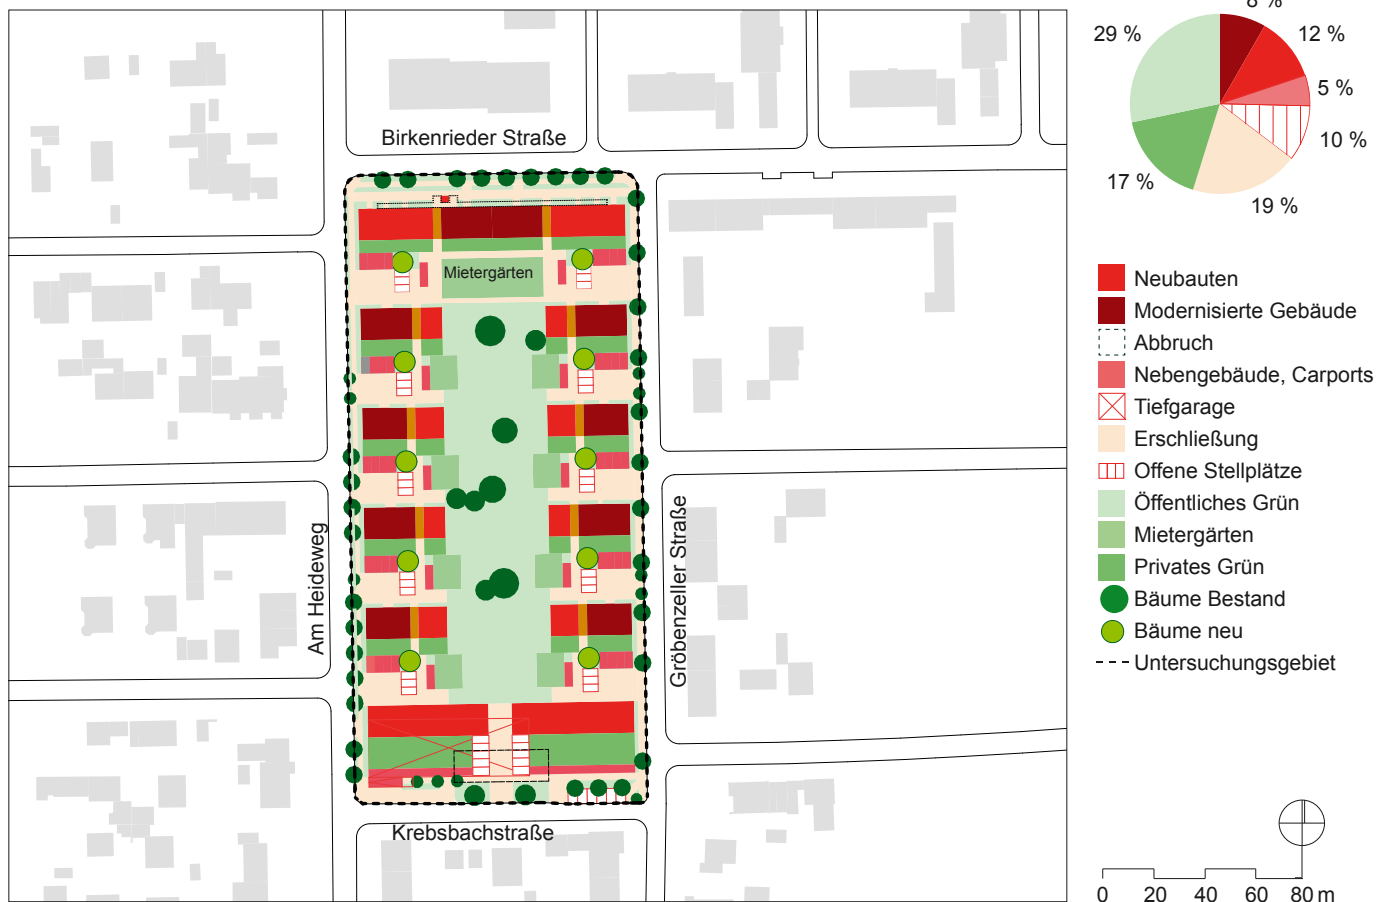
Lageplan Dachau, Altbestand mit Flächenaufteilung
